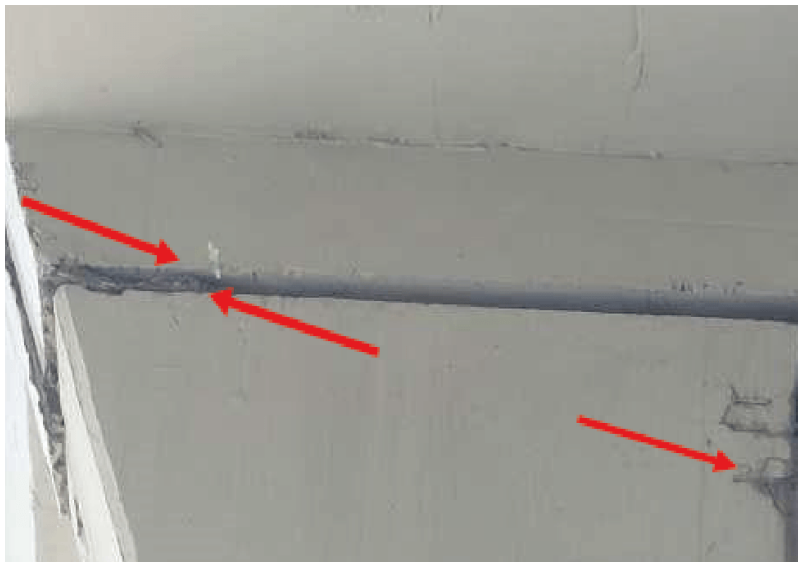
Estruturas com incrustação biológica em pilares e vigas de travamento
